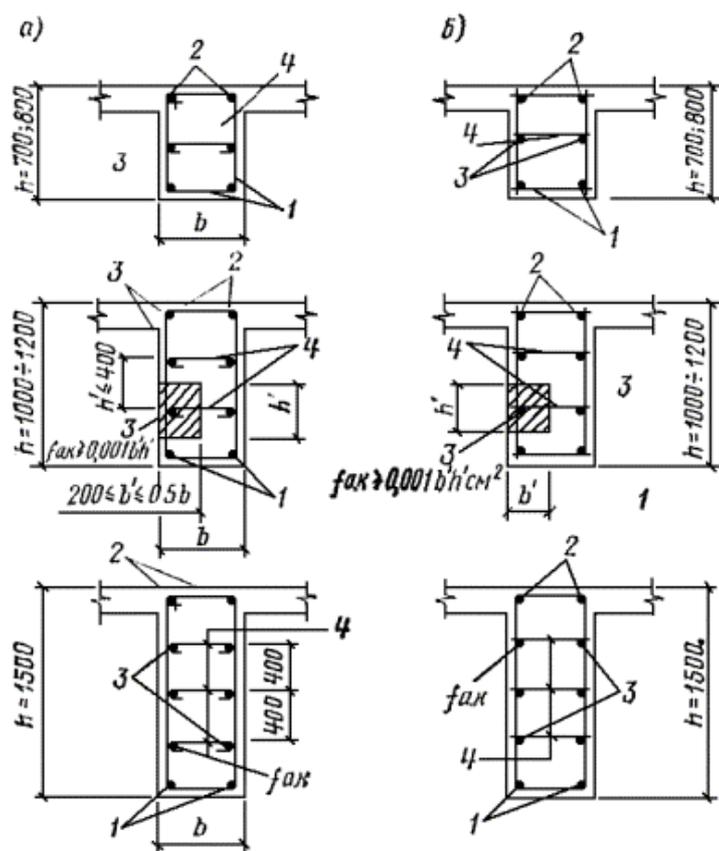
Схемы поперечных сечений монолитных балок перекрытия
